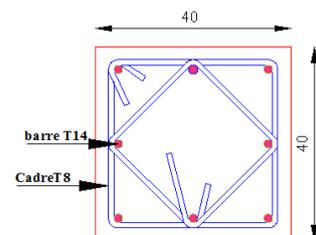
détail d'un poteau en béton/ Source : [www.archimaperial.com](http://www.archimaperial.com)
